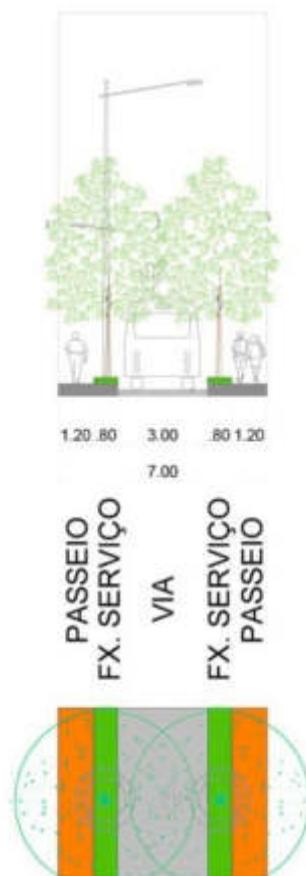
Seção B, R. Idelfonso Cavalcante – Seção Proposta. Elaboração Idom.
